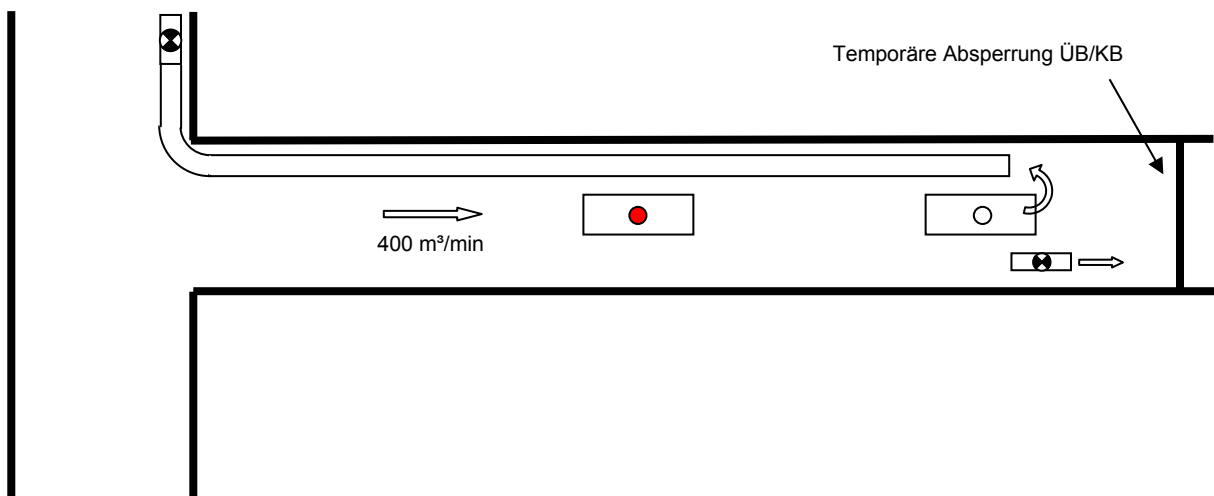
Bewetterung Einlagerungsbetrieb
